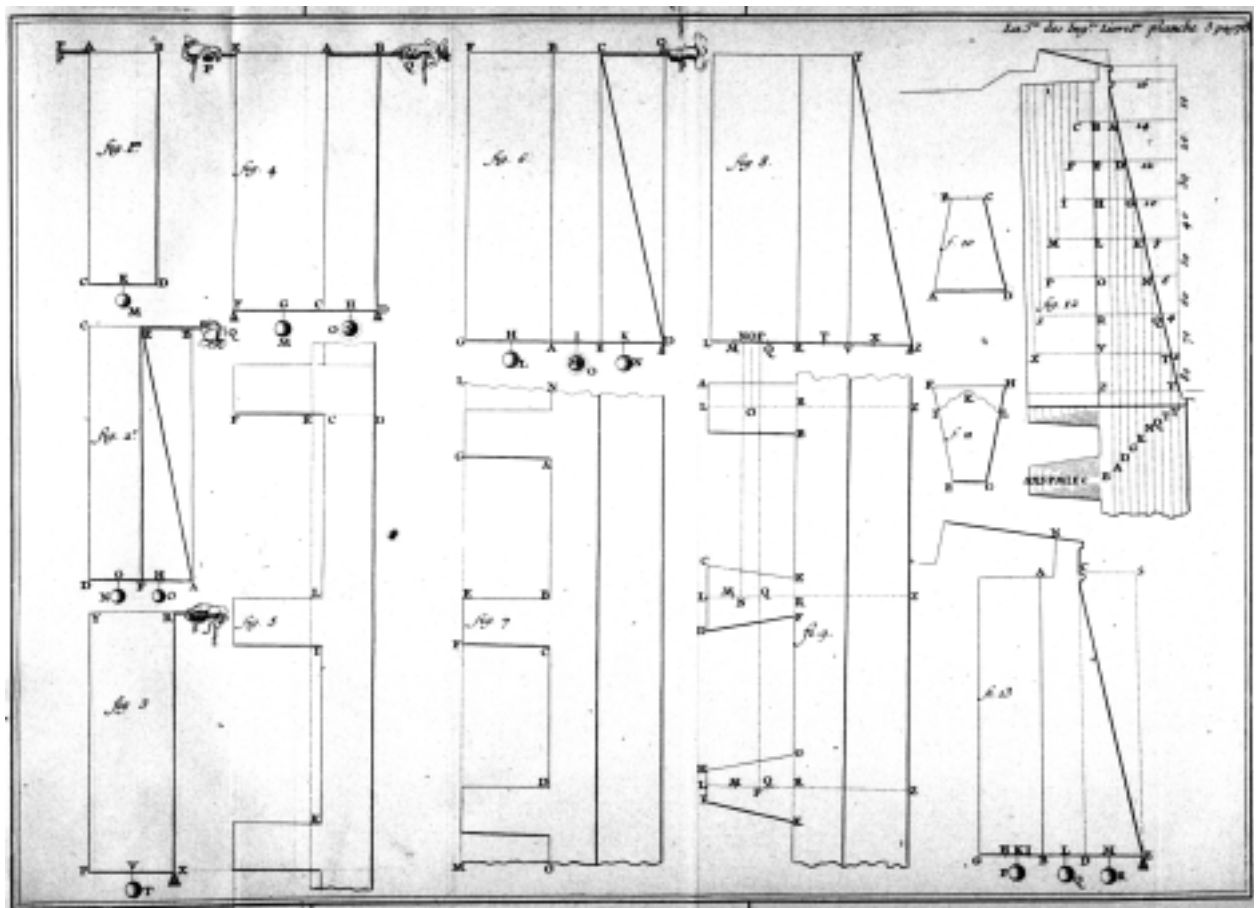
Belidor M.D.CC.XXII. (1722). Buch 1. Plan 3.
